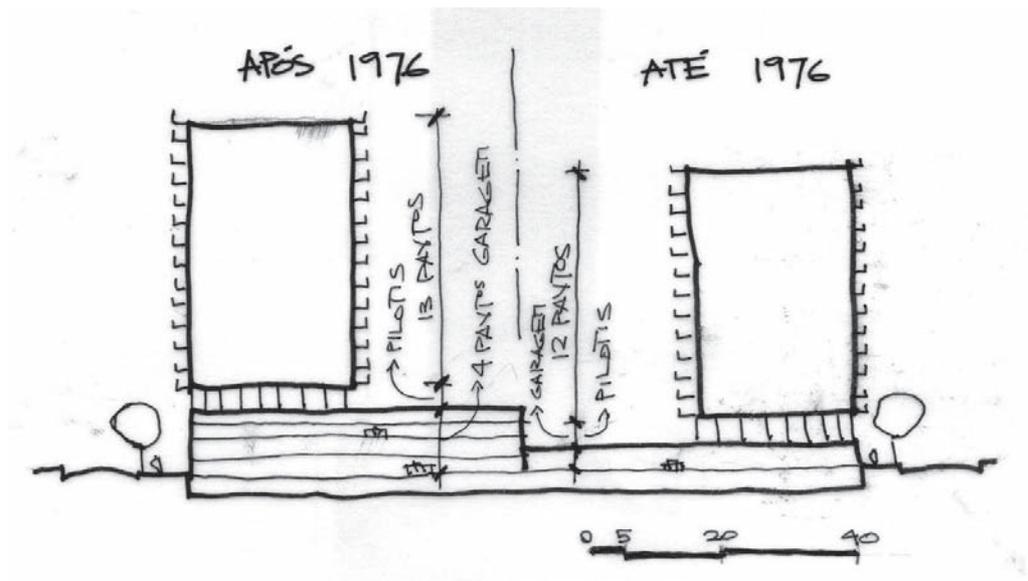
Croqui com o perfil após a implantação do embasamento garagem em 1975
